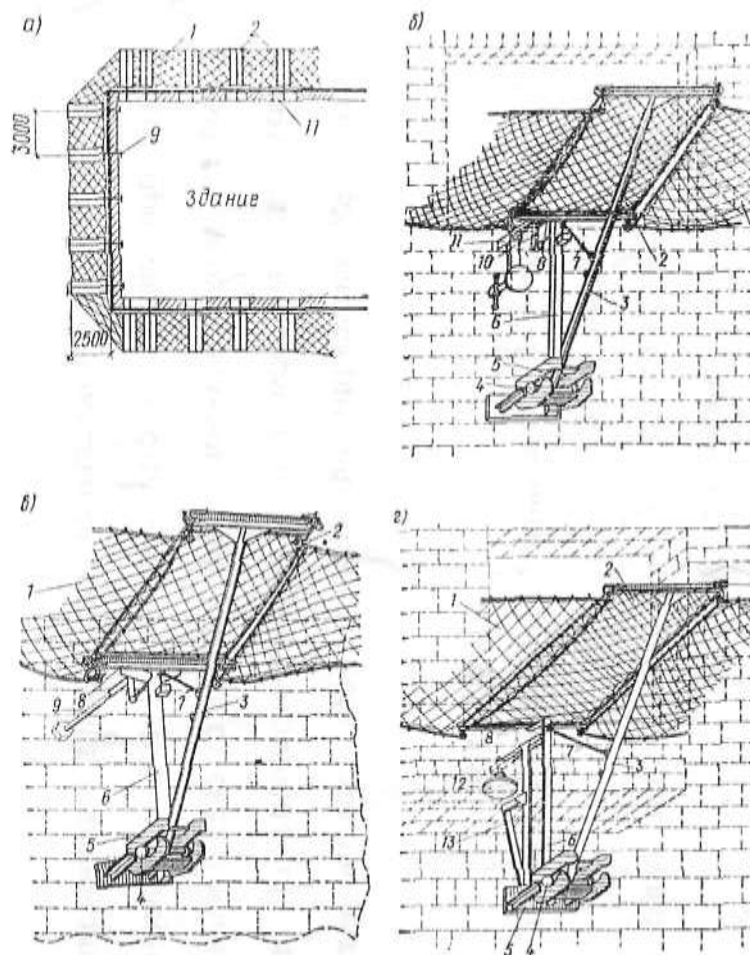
1 - сетка большая; 2 - сетка малая; 3 — штанга; 4 — ось штанги; 5 - подпятник опоры с проушинами; 6 - стойка; 7 - строп страховочный в - опоры поперечные; 9 - пробка; 10 - штырь опоры; 11- струбцина; 12 - при-прижимы; 13 - кронштейн
